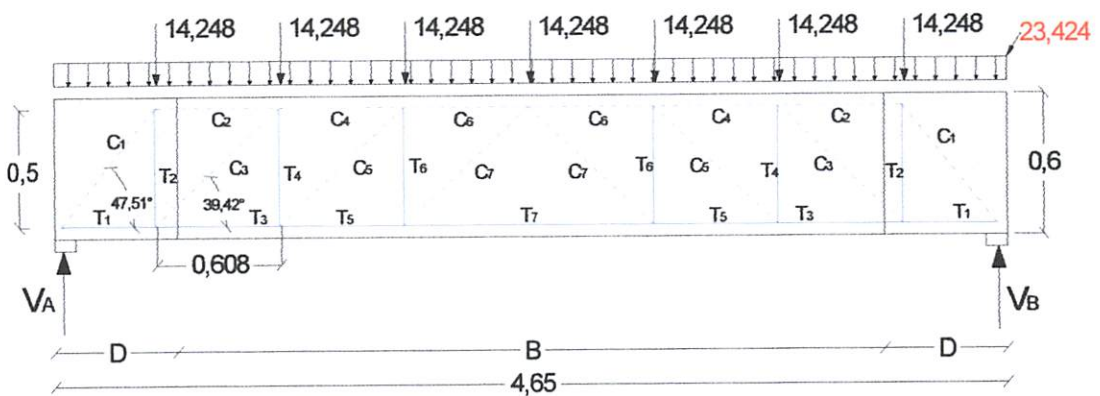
Strut and tie model dari suatu balok beton dengan beban merata p
